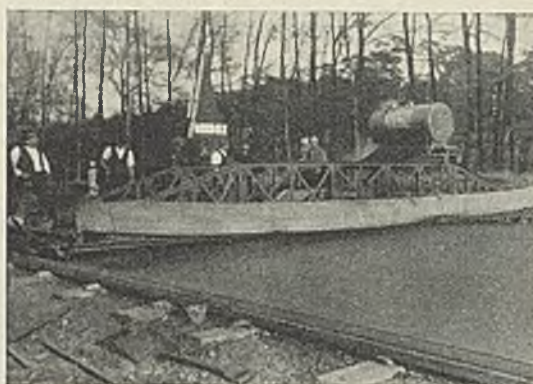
Bearbeitung der Teerbeton-Deckschicht mit dem „Dingler“-Straßenfertiger.
